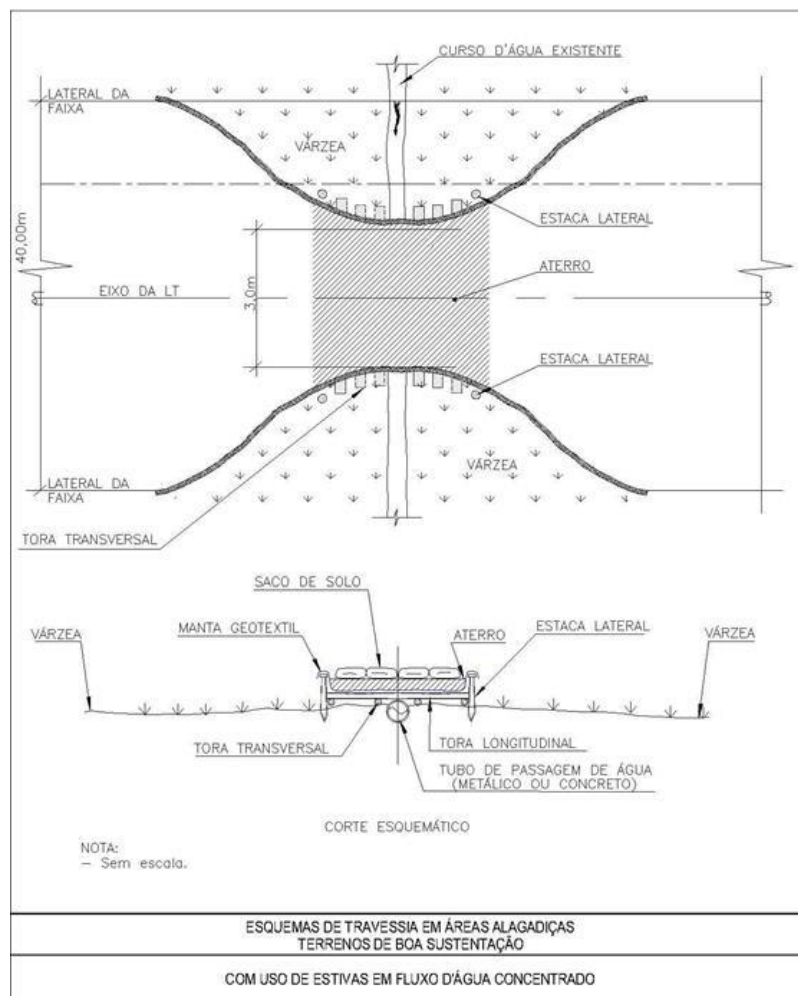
Construção em áreas de várzea, em terrenos de boa sustentação.
